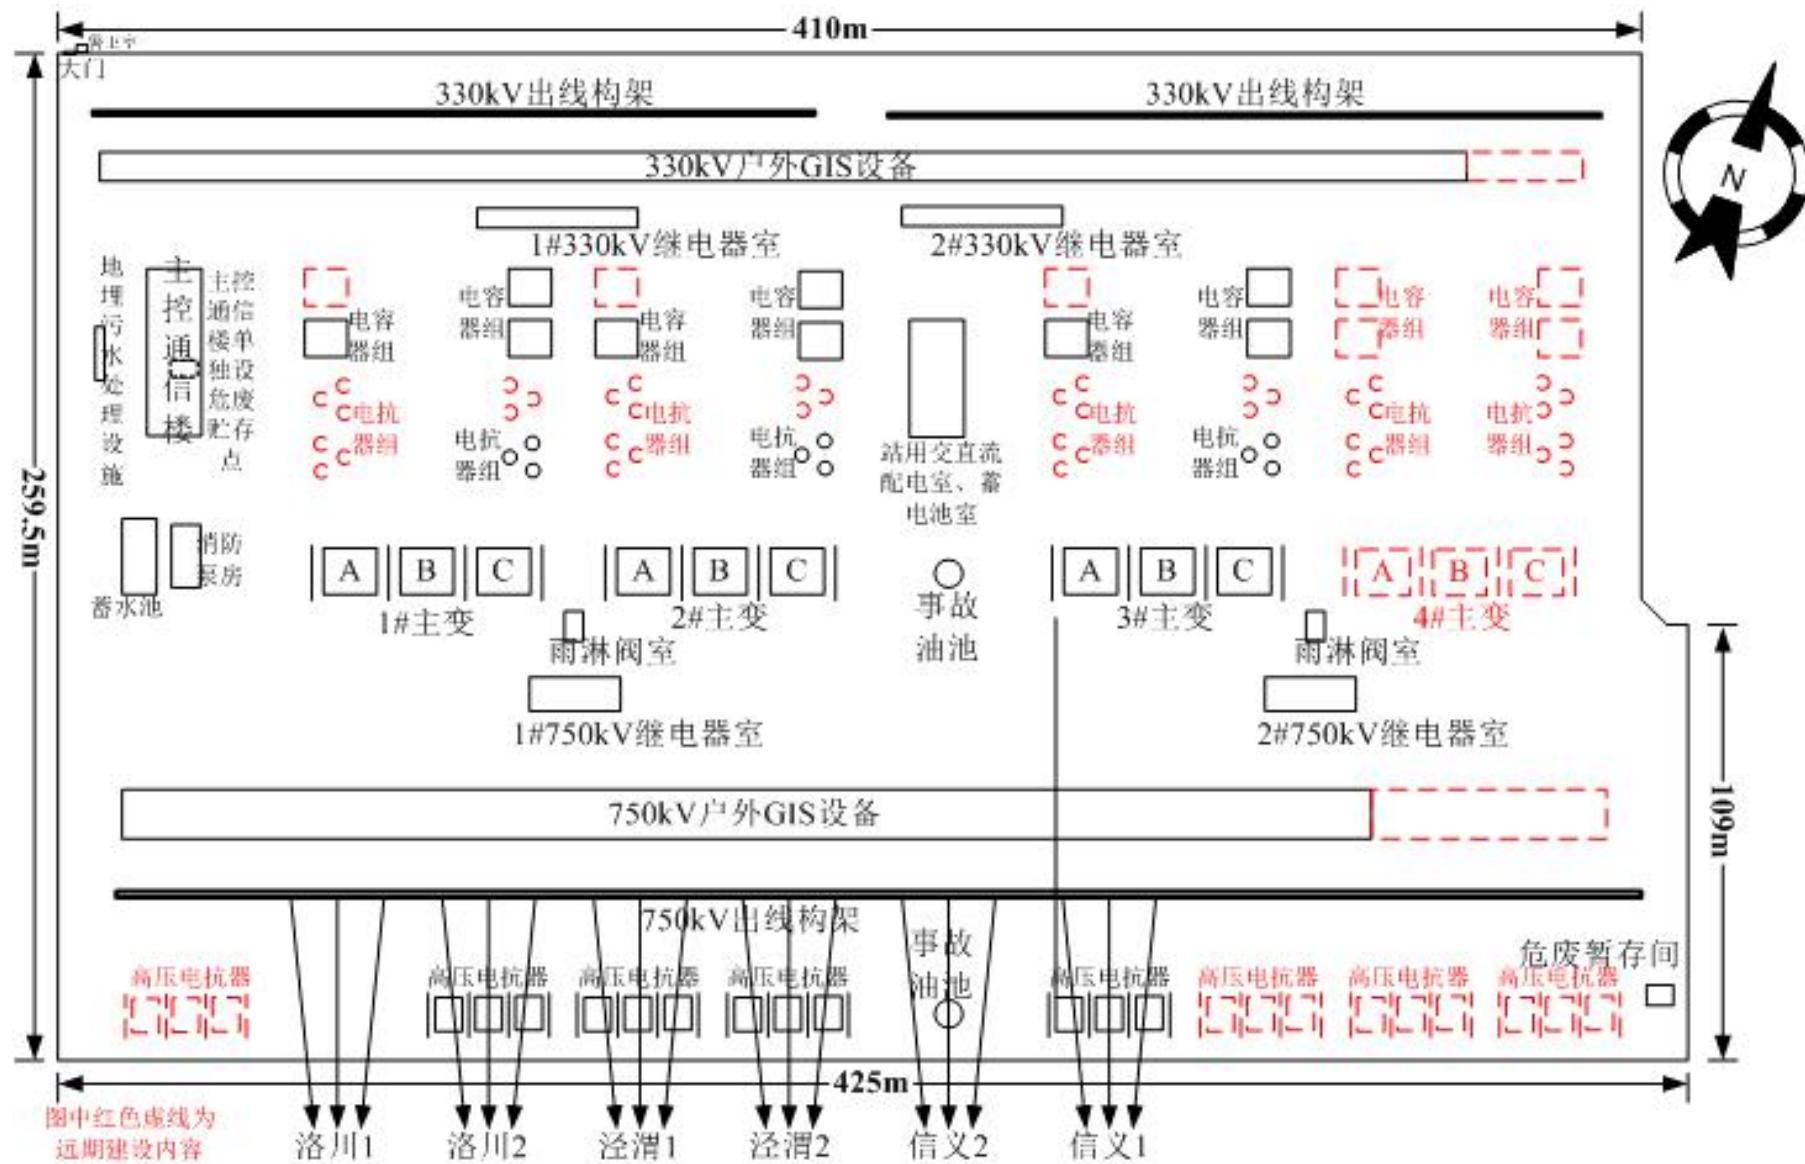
蒲白 750kV 变电站平面布置示意图
